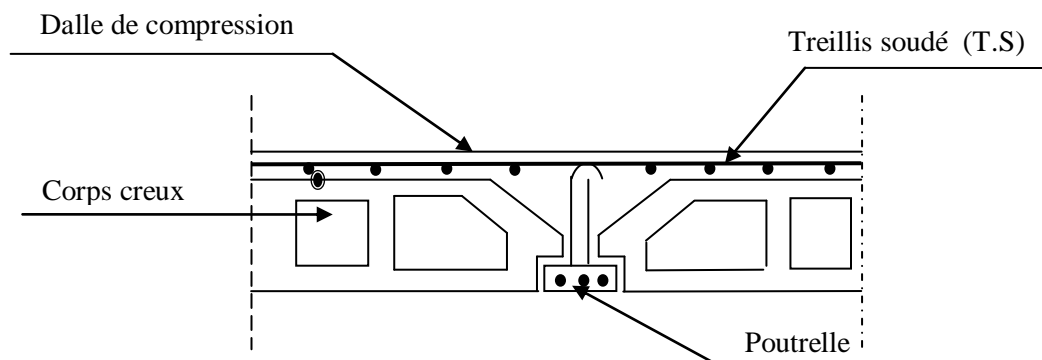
Coupe transversale dans un plancher en corps creux
